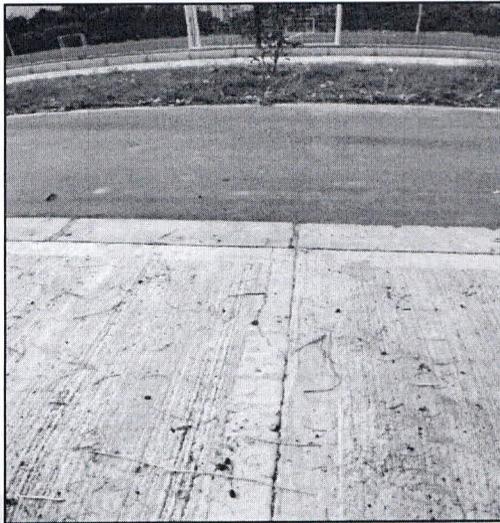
Fisuras en andén perimetral entre lago y cancha múltiple con referencia de cicloruta entre k0+082 -k0+110
